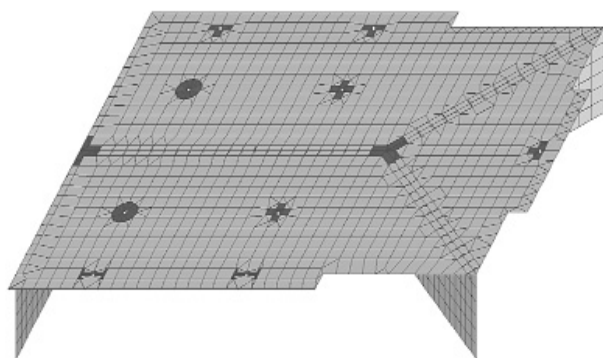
Схема МКЭ перекрытия с генерацией АЖТ
